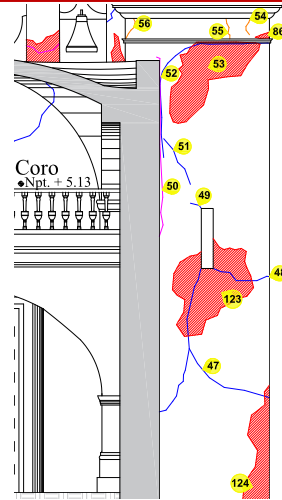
Desprendimiento de aplanados y colapsos parciales en torre campanario fachada sur
